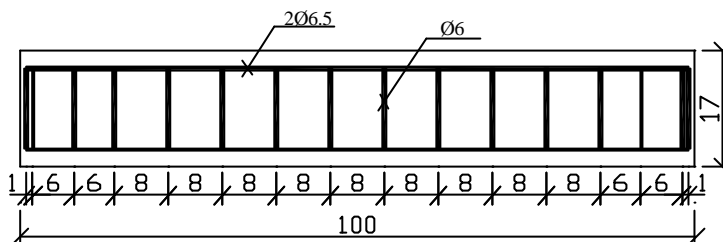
Seções transversais e disposições das armaduras das vigas ensaiadas.
